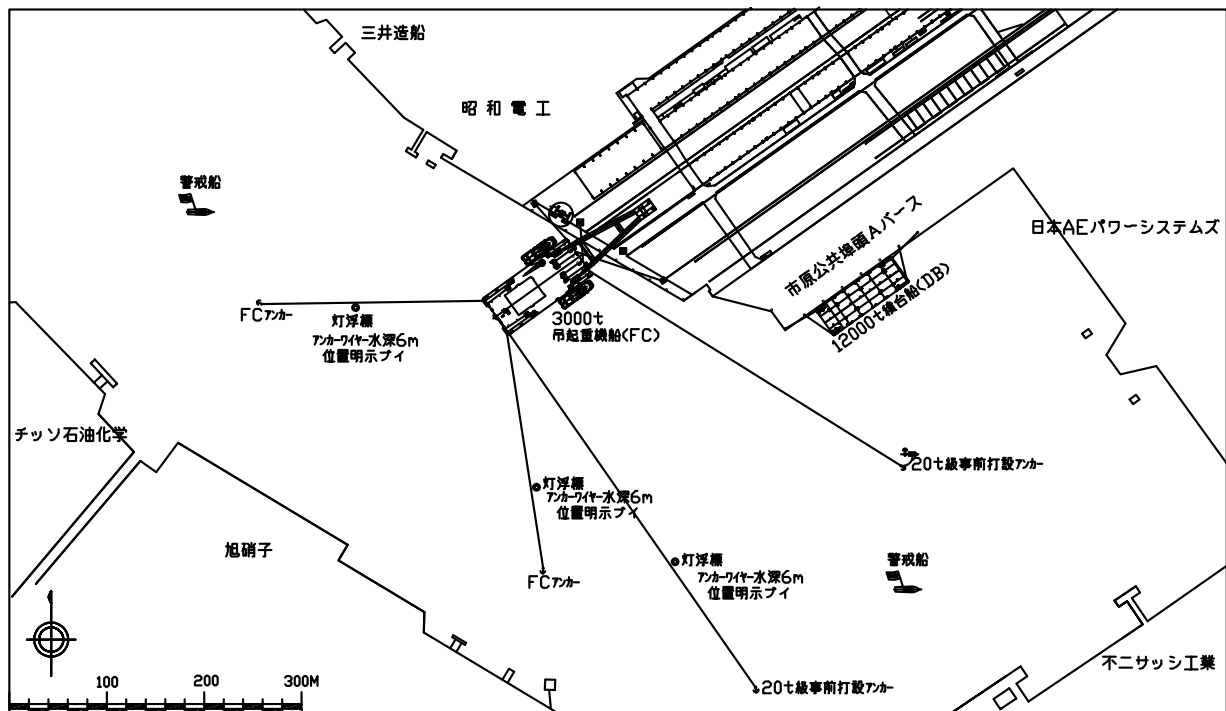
浜出しの作業時の平面図（東京ゲートブリッジ）
